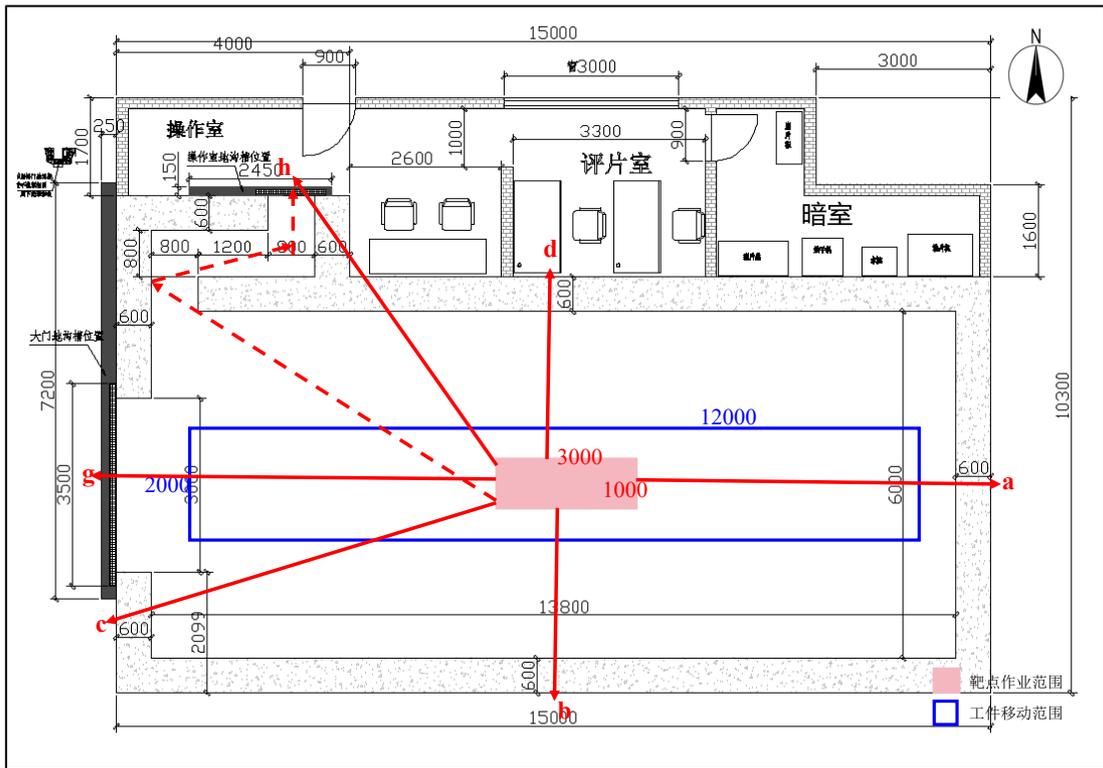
XXH-2505 型探伤机工作时平面布局与预测点位图 (单位:mm)
